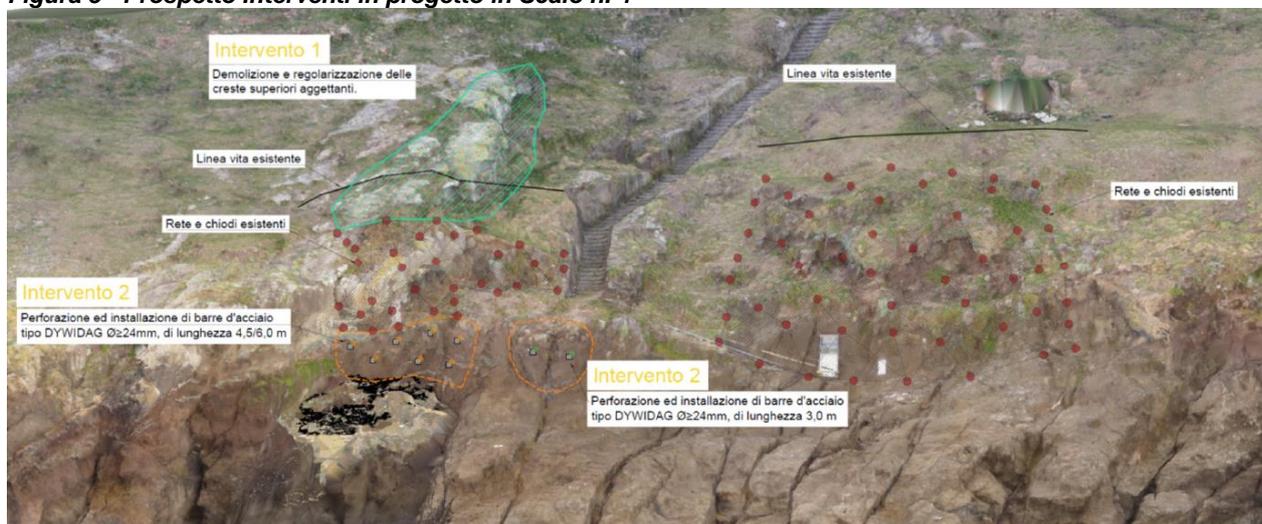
Prospetto Interventi in progetto in Scalo n. 4
